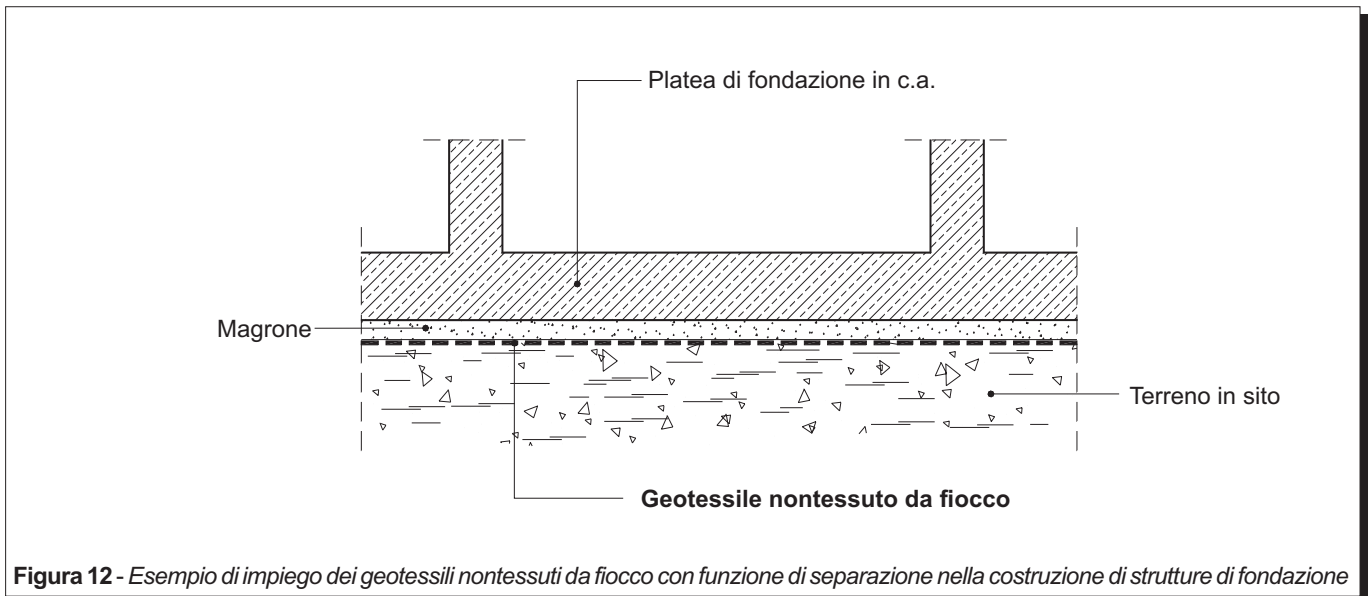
Esempio di impiego dei geotessili nontessuti da fiocco con funzione di separazione nella costruzione di strutture di fondazione
